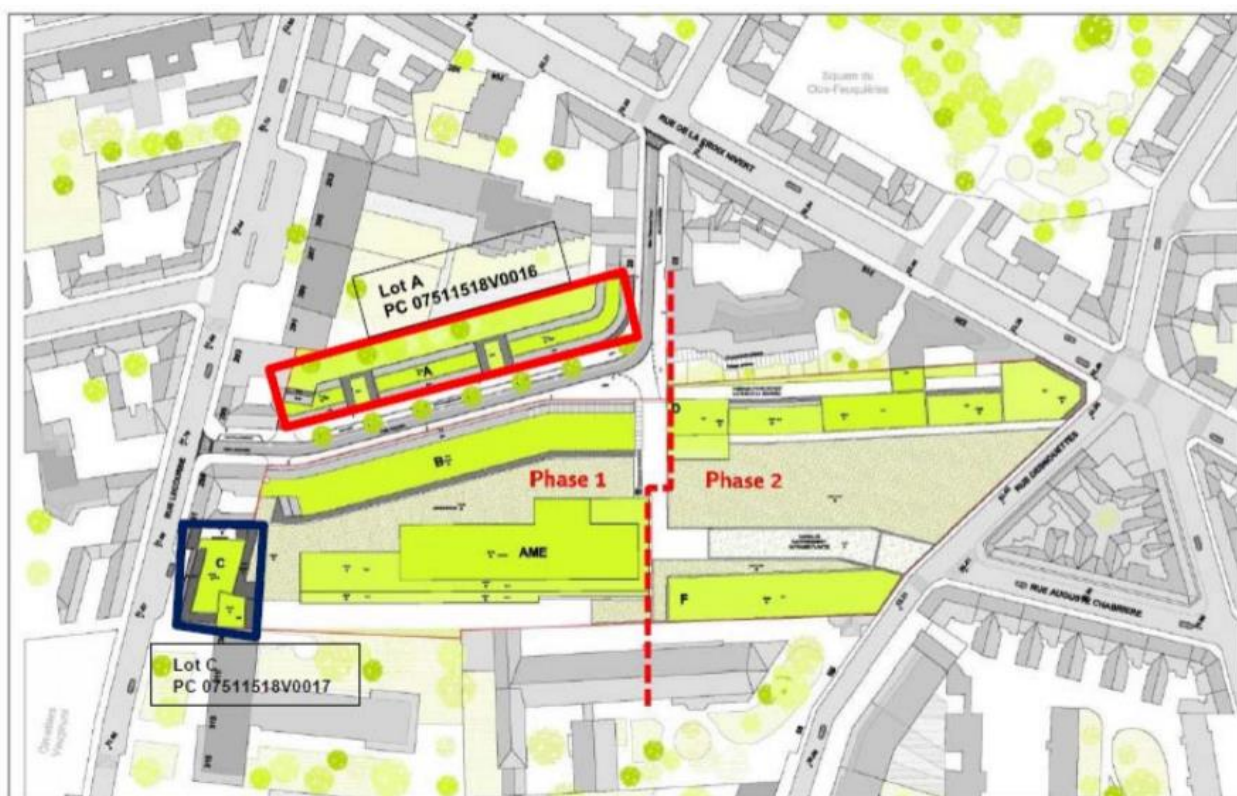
Plan du projet et des lots A et C (Source : dossier)
